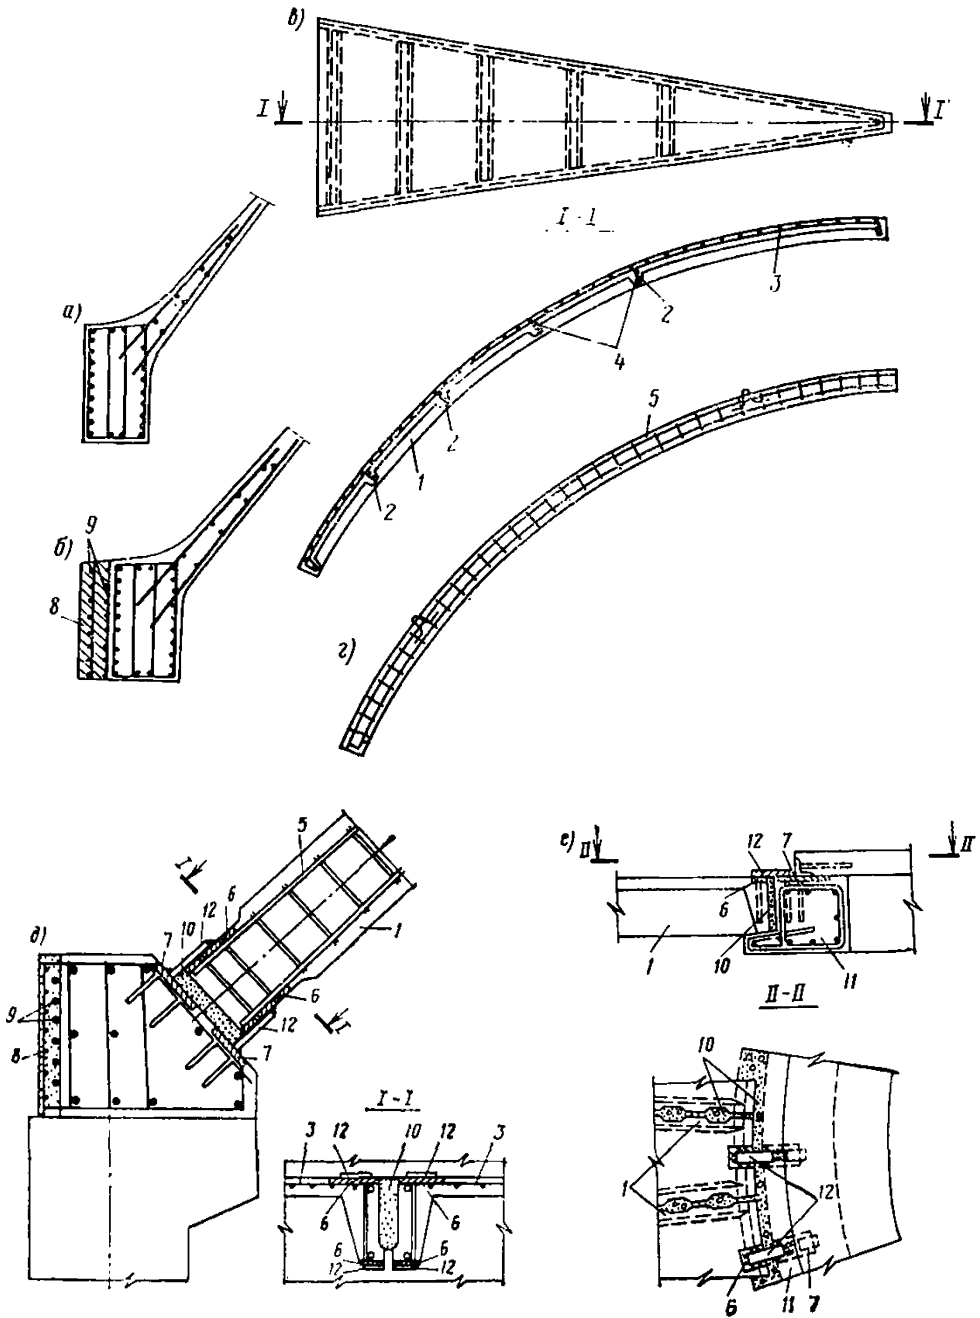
Армирование монолитных и сборных железобетонных куполов и их элементов
